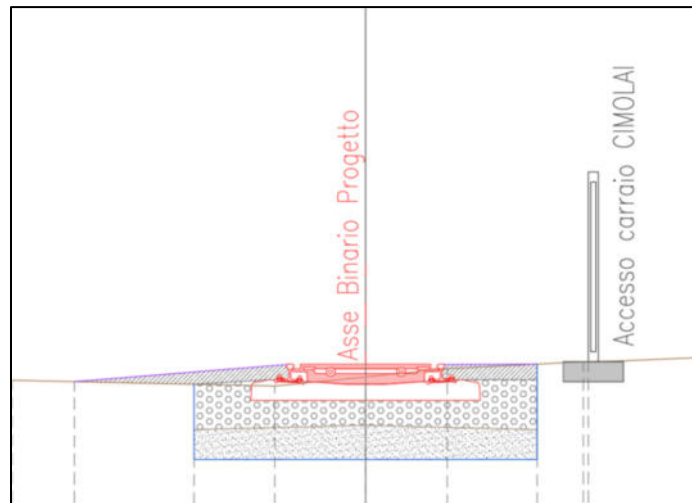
Sezione di progetto in corrispondenza dell'accesso Cimolai
